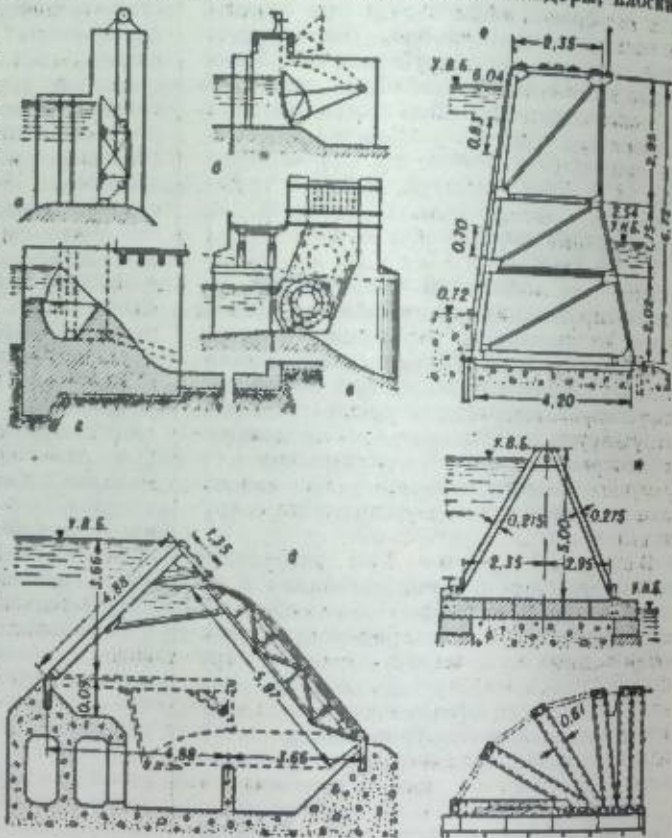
Схемы поверхностных затворов: а — плоский затвор; б — сегментный; в — вальцовый; г — секторный; д — крышевидный; е — поворотные фермы; ж — поворотные рамы.
